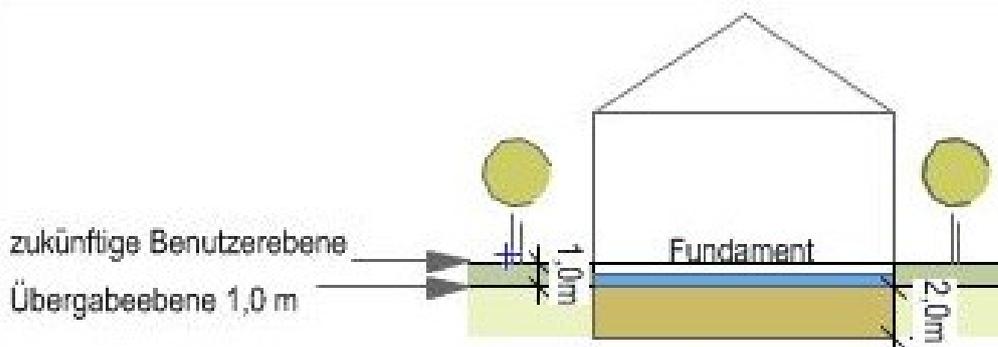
Baugrundaufbereitung gemäß Sanierungsplan für das Gelände Haus Aden 1/2
